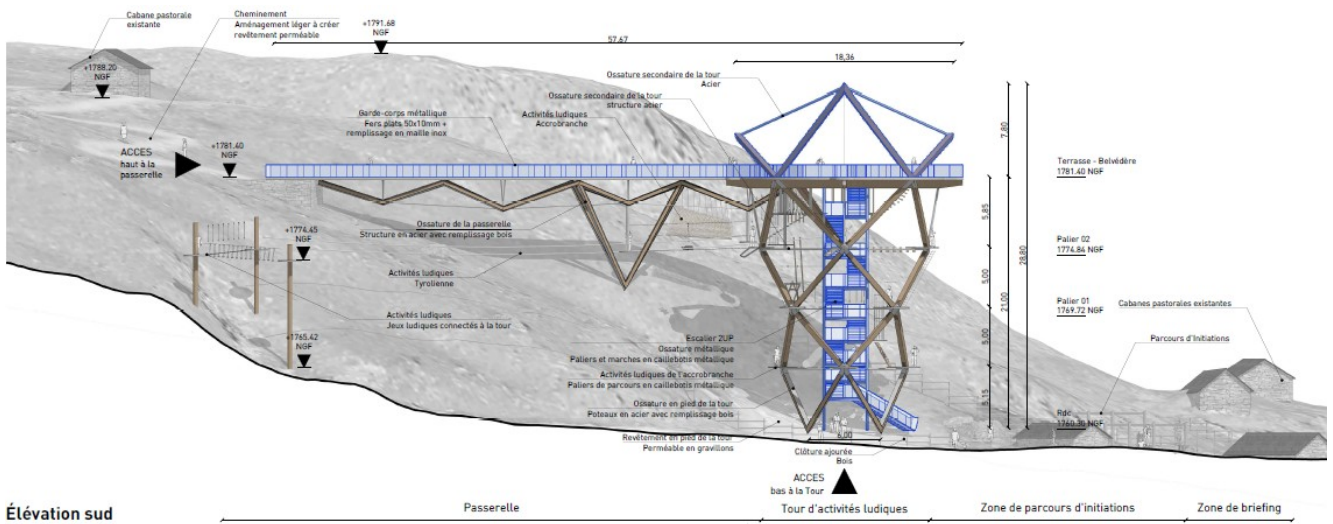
Plan des façades au sud (pièces du permis de construire données en complément)
